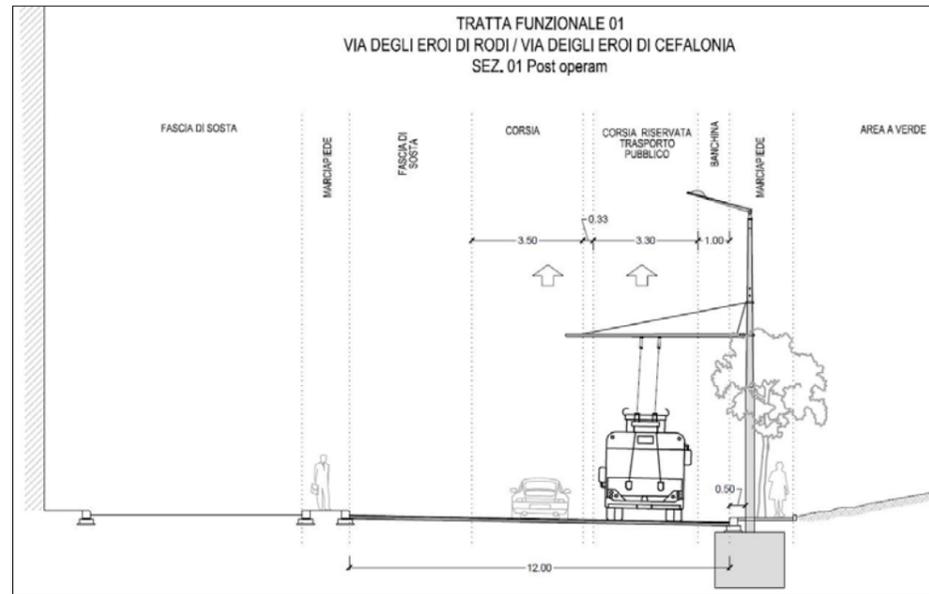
Sezione trasversale di progetto viale degli Eroi di Rodi
